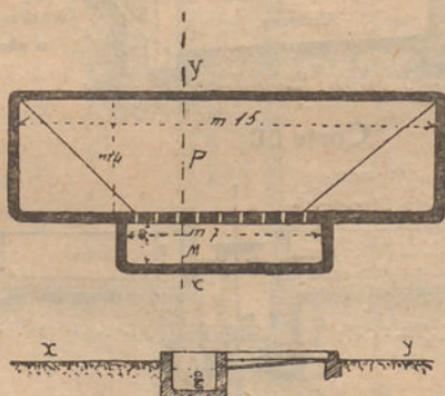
Estrumeira com fossa, de um só pavimento—Planta e corte
